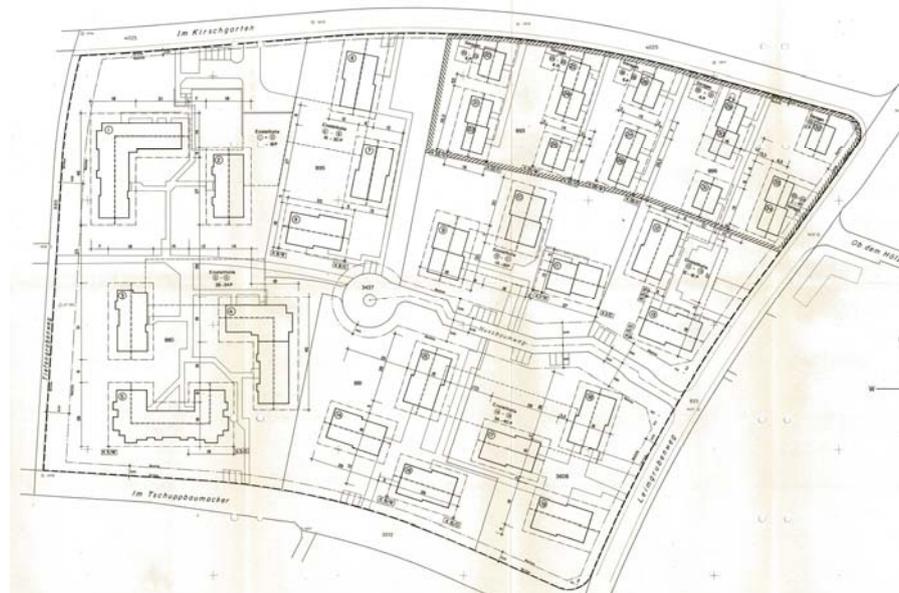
Rechtsgültiger Quartierplan „Kirschbaumacker“, Situationsplan
